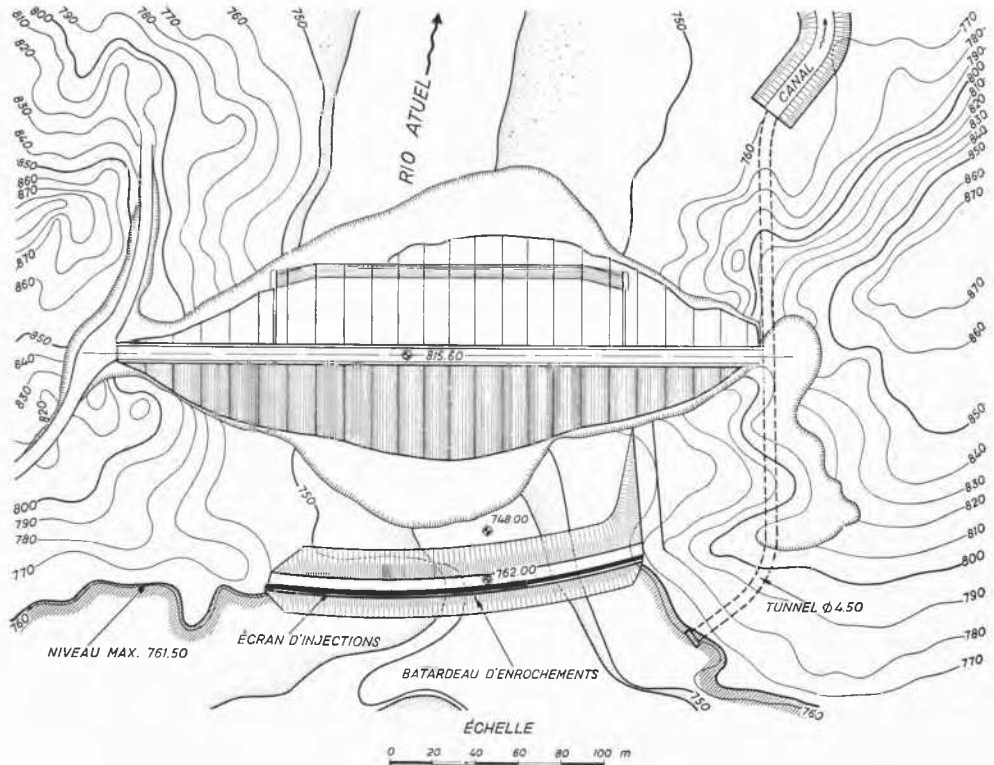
Plan du barrage et implantation de l'écran imperméable.
